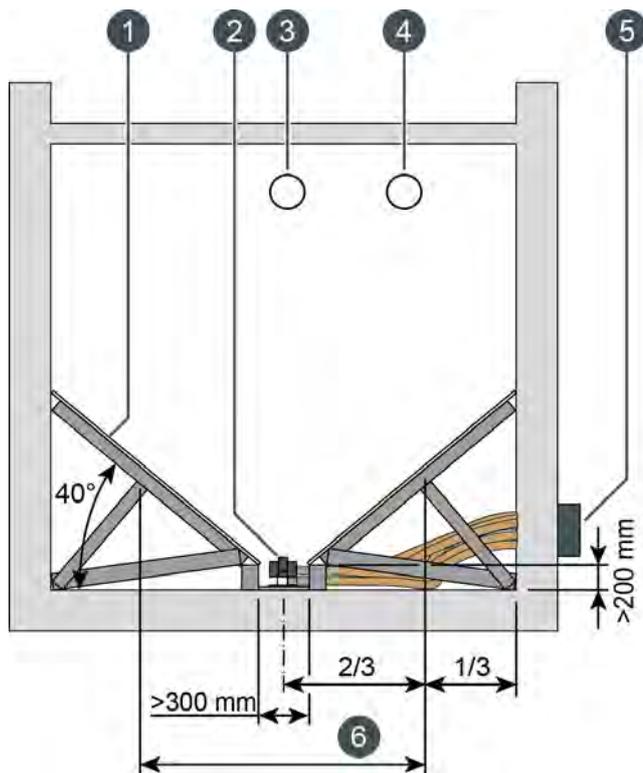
Construction du plancher incliné pour les sondes d'aspiration
